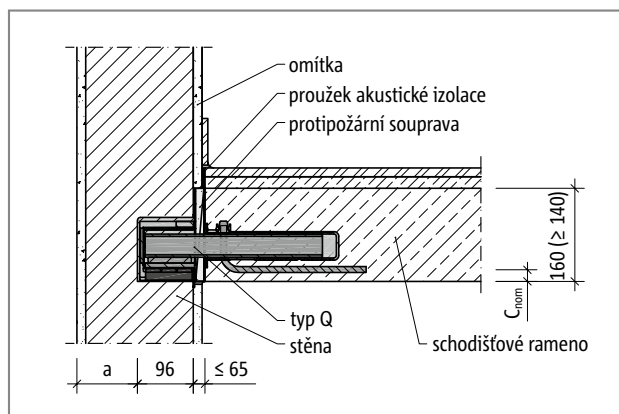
Schöck Tronsole® typ Q: Otvor ve stěně u prefabrikované konstrukce
